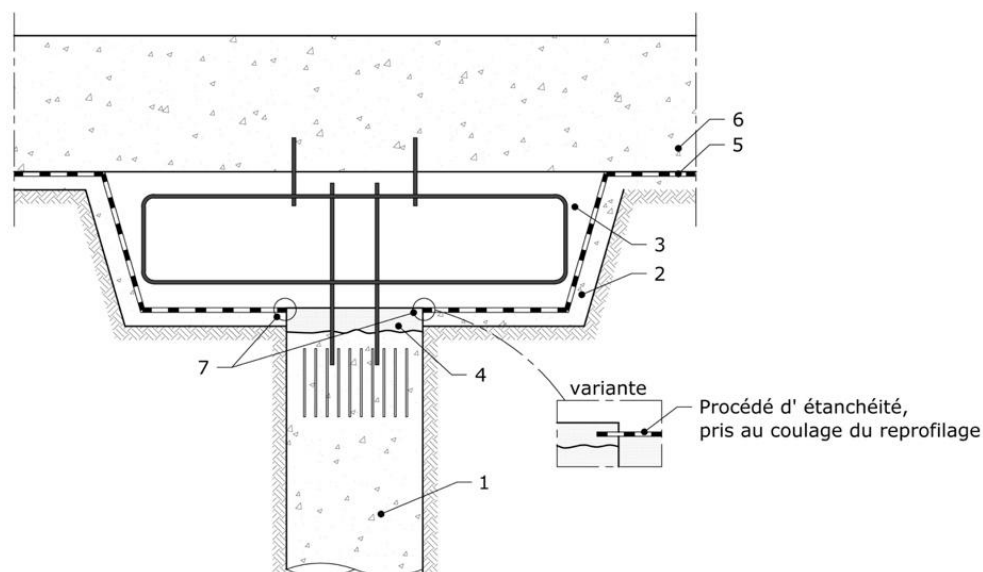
Exemple de traitement d'un poteau en béton ou barrette préfondé
